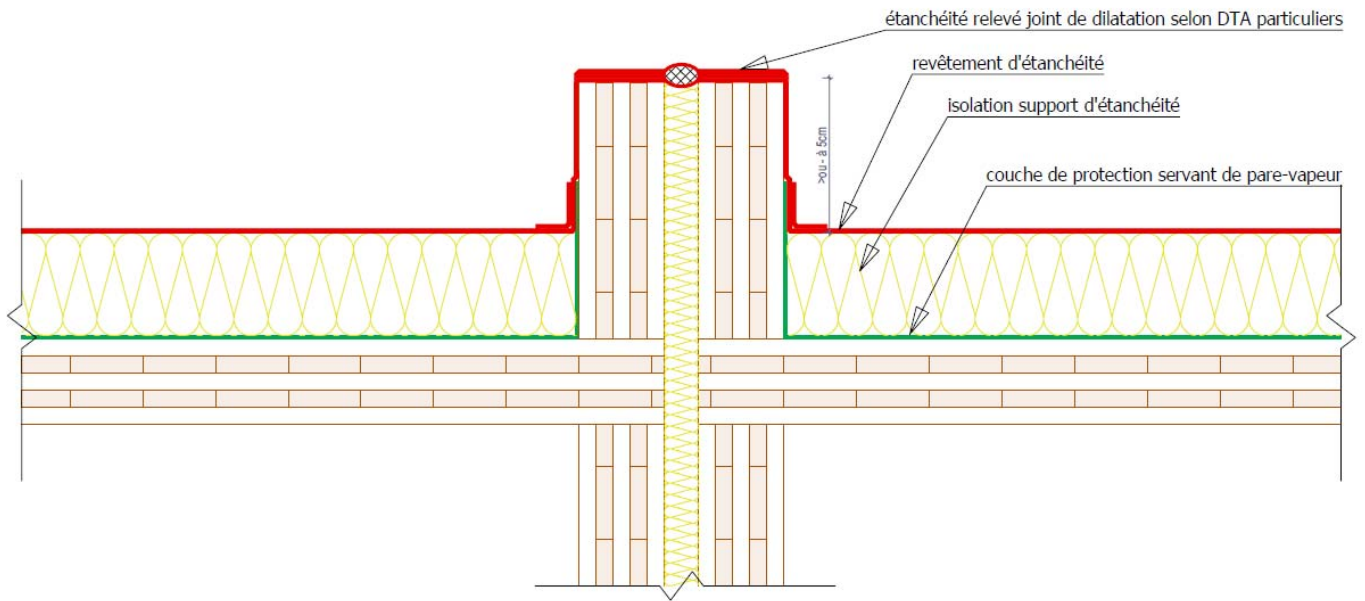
Exemple de jointoiment des panneaux CLT BBS sur un joint de dilatation en costières bois massif ou en panneau CLT BBS dans le cas d'une toiture terrasse accessible
